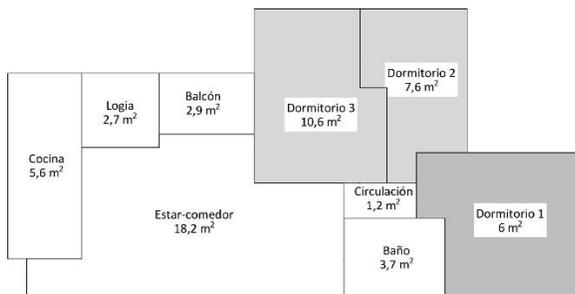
Áreas Don Eduardo. Fuente: Elaboración propia
